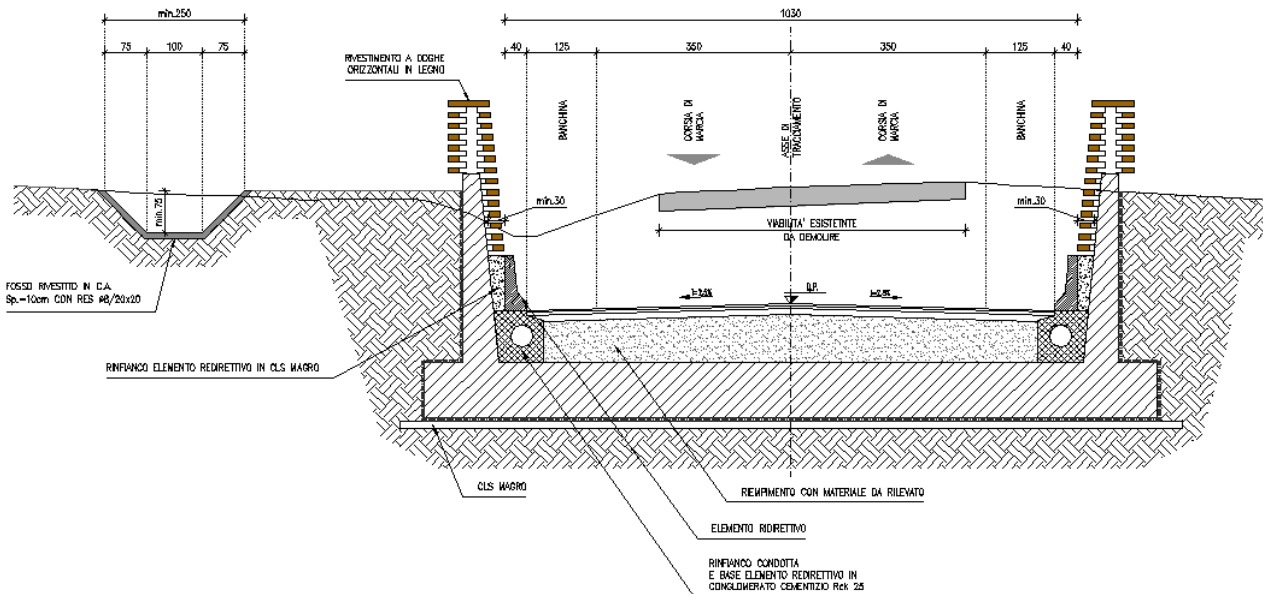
SEZIONE TIPO TRINCEA.
